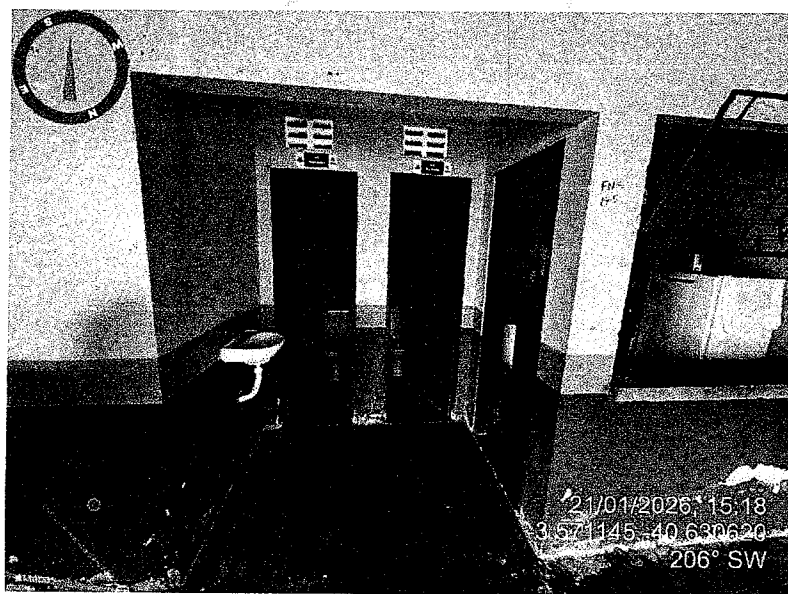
VISTA DOS BANHEIROS AO LADO DA CANTINA
